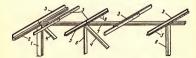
Схема укладки балок на верхнюю обвязку внутренней несущей стены:
